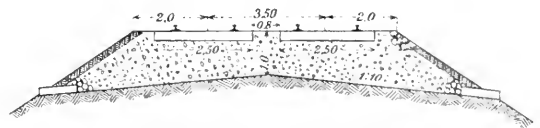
Bettungsquerschnitt für einen Bahndamm aus Tonboden, nach Schubert.
